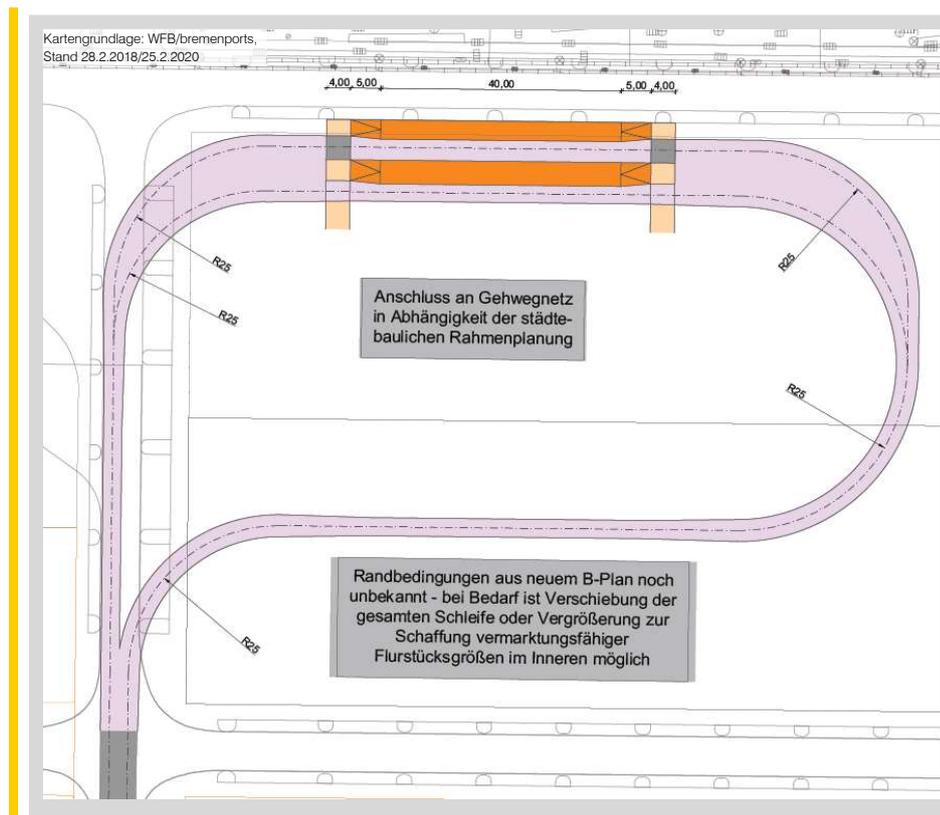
Ausschnitt Lageplan Blockumfahrung Überseehafen
